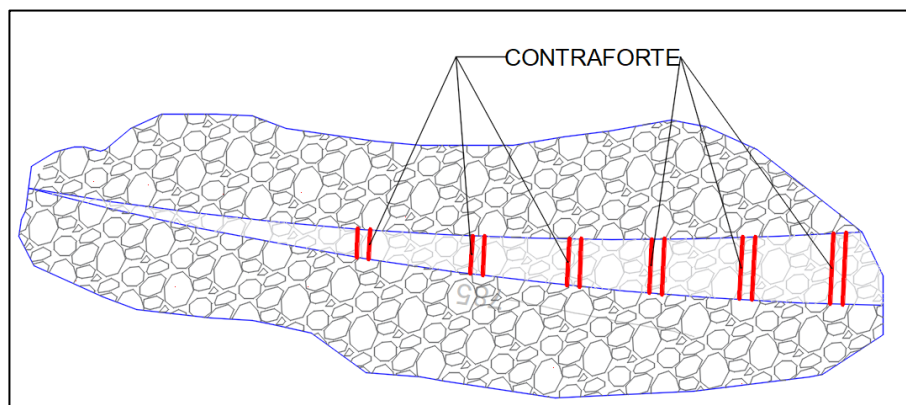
Planta baixa esquemática com implantação dos contrafortes na rocha 06.
